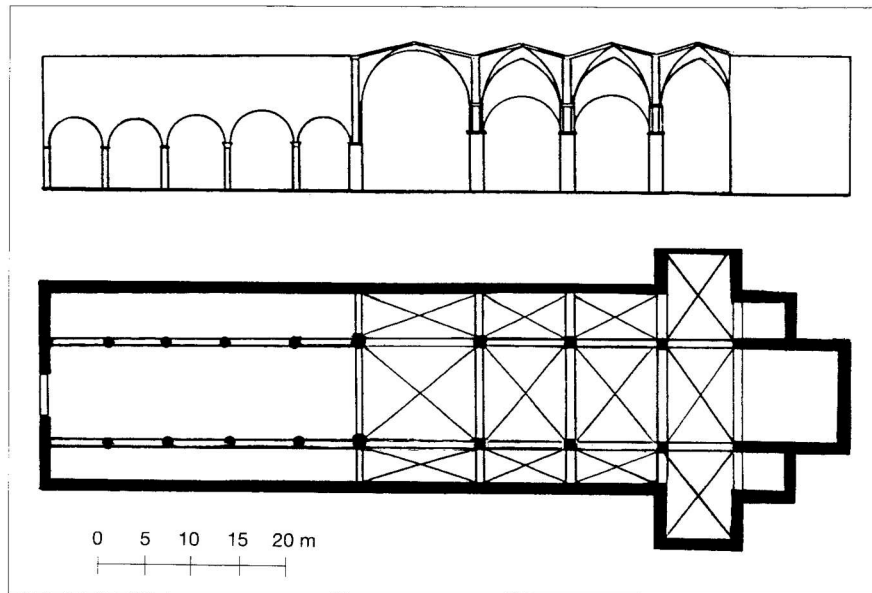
Bologna, Predigerkirche (um 1233); rekonstruierter Grundriss und Längsschnitt.
